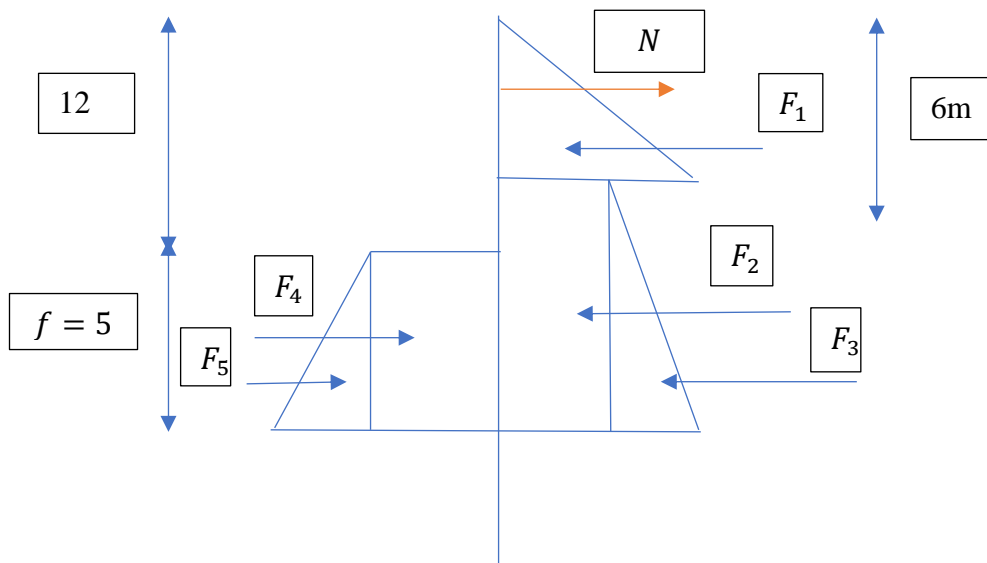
Présentations des pression et force de tirant d'encrage appliqué sur la palplanche cas profondeur d'excavation 12m
